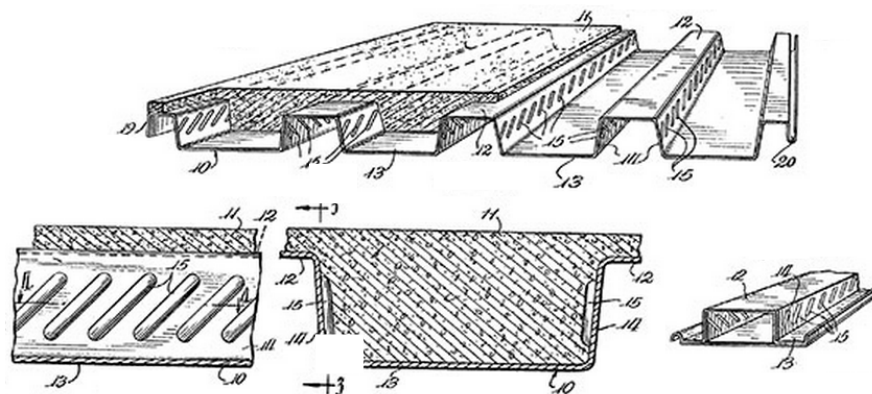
Laje mista *Hibond* (adaptado de Structuremag, 2013).
